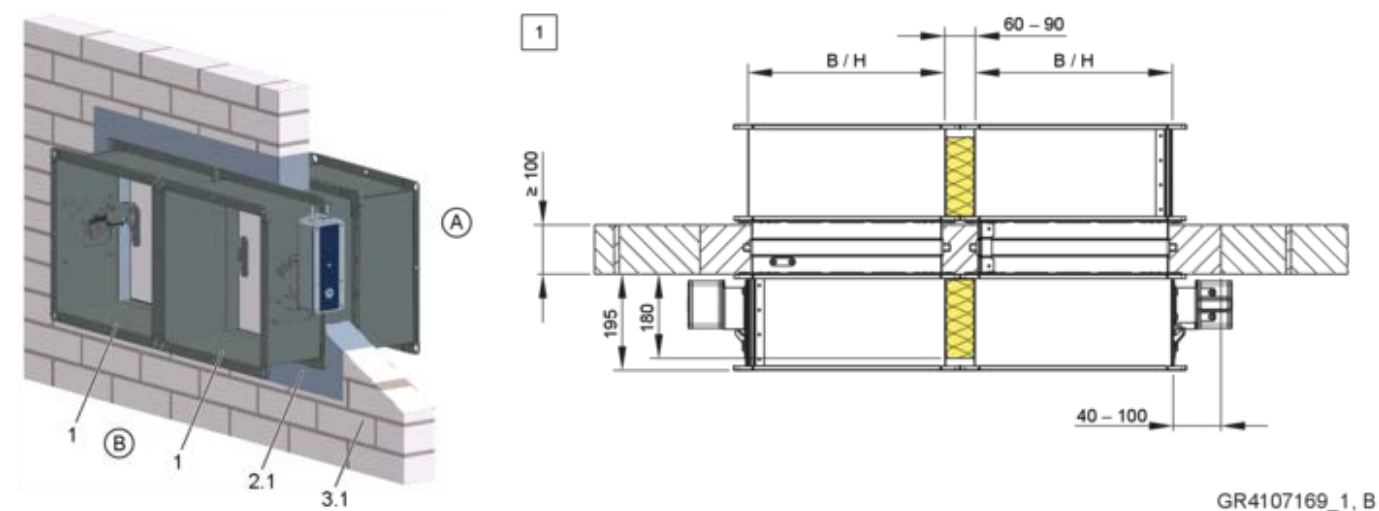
Montagem em argamassa numa parede maciça, "flange a flange" A ilustração mostra a montagem lado a lado (também se aplica à montagem de registos um por baixo do outro)
